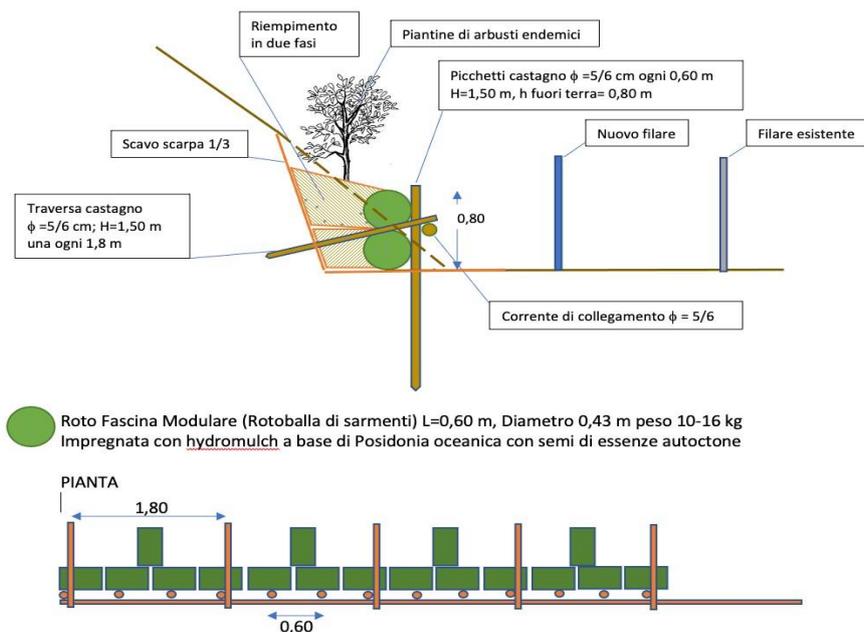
Schema di sezione tipo e pianta prototipo A1.
